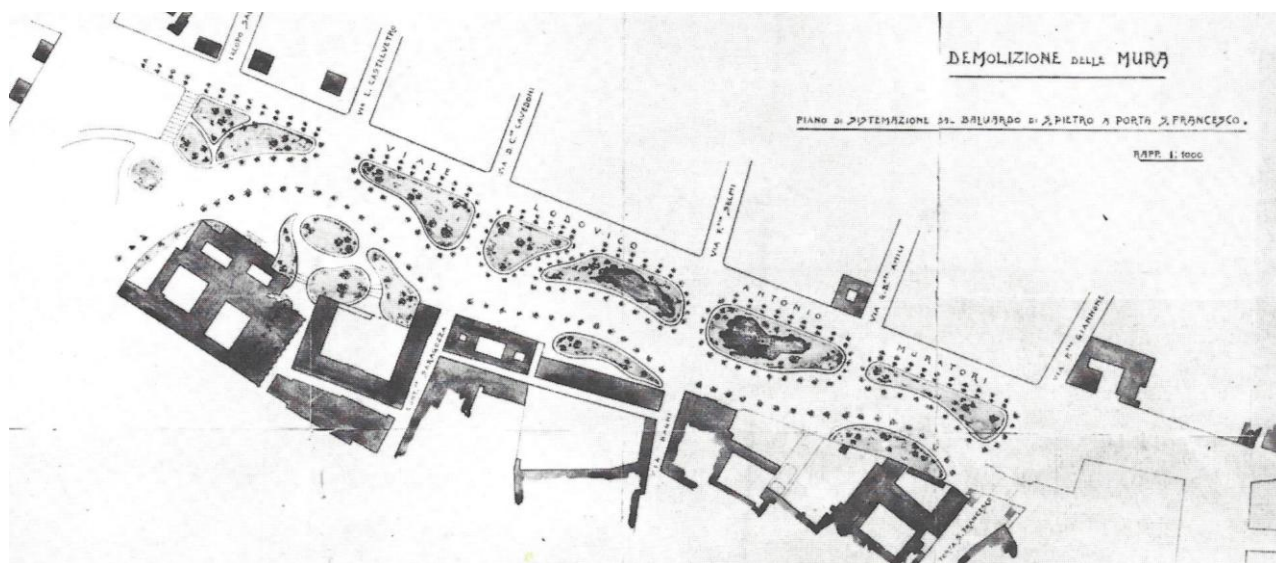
progetto del 1923 per la sistemazione dei nuovi viali a seguito della demolizione delle mura.
